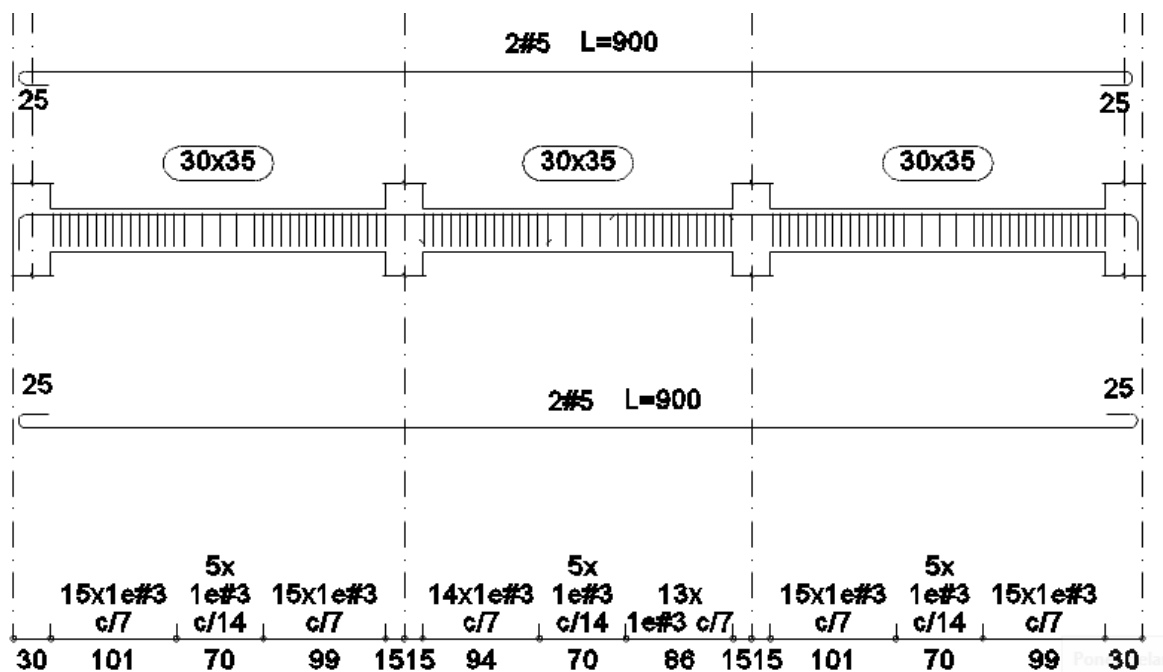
Planos de distribución de aceros en vigas V1 de entre piso. Fuente: Arquitecto.
